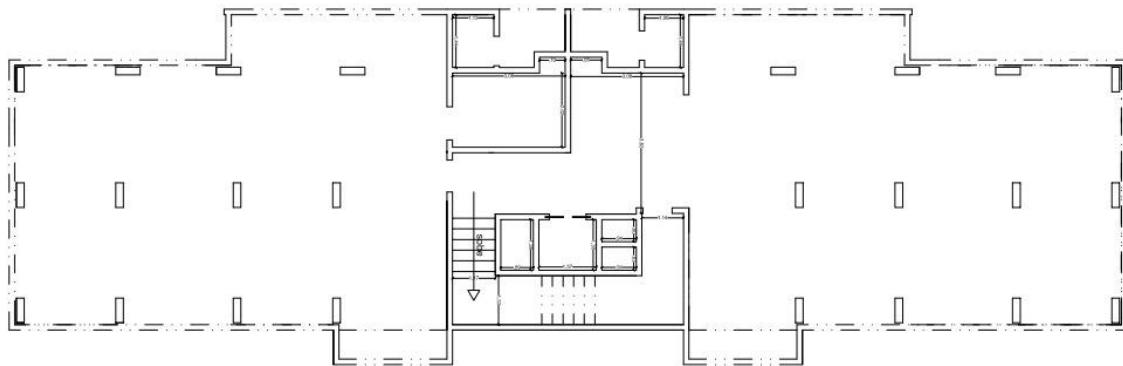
Planta baixa (croqui) do Térreo (Bloco A)
